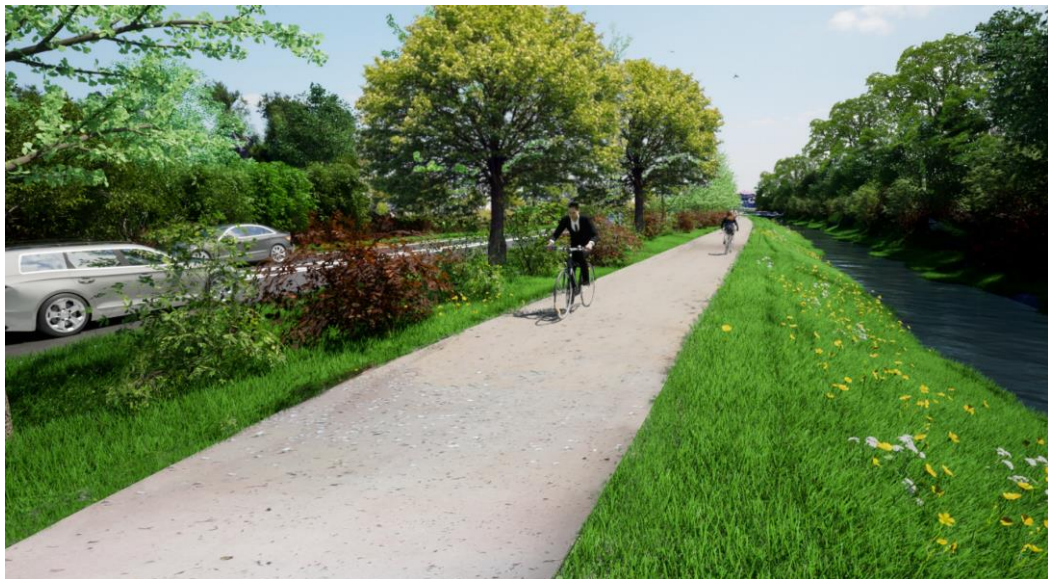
Pista ciclabile lungo l'arginatura dell'allacciante di Levante
